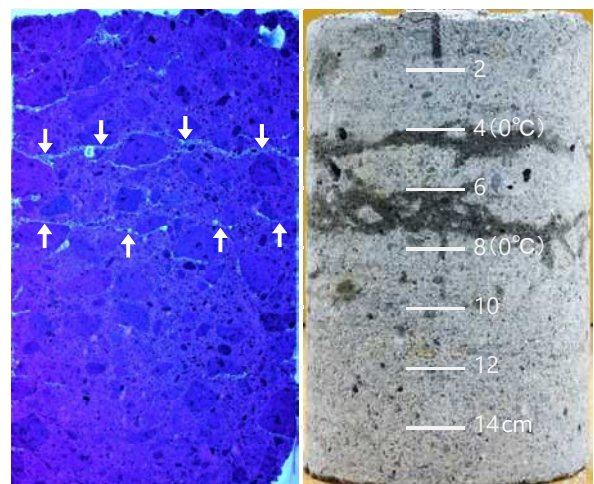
0°C点付近で発生した水平ひび割れと水濡れ
